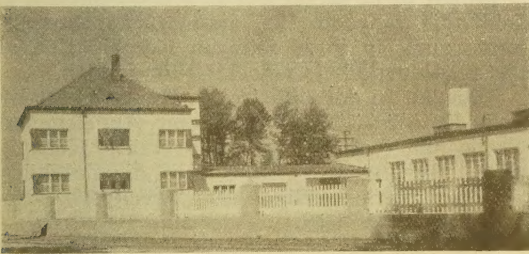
Gesamtansicht des Wohnhauses für zwei Maschinenwärter.
